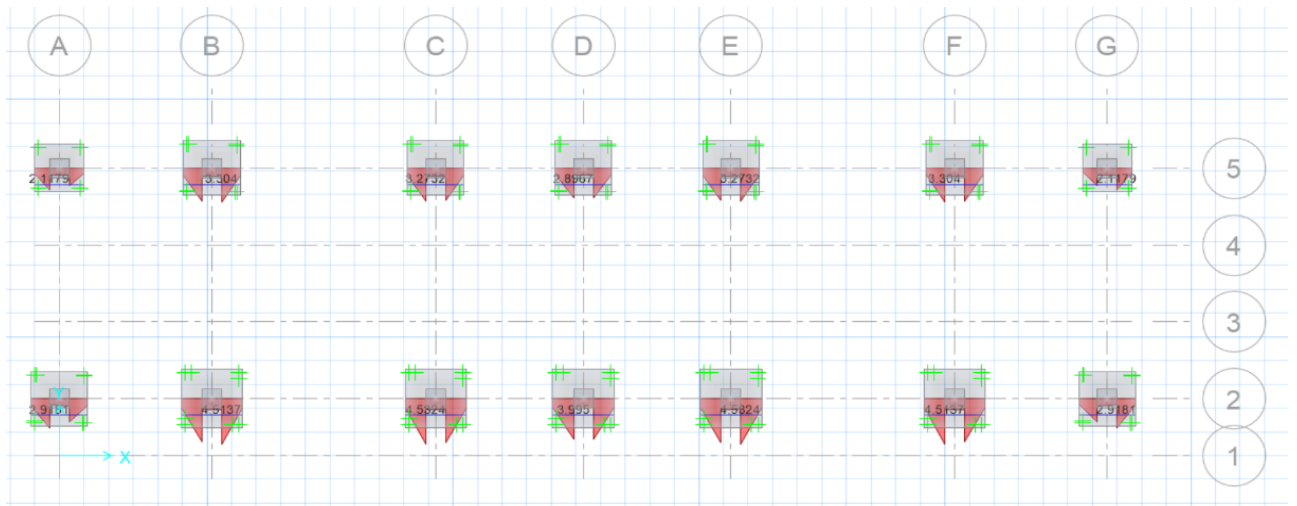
Armadura de refuerzo a flexión en zapatas aisladas eje y.
